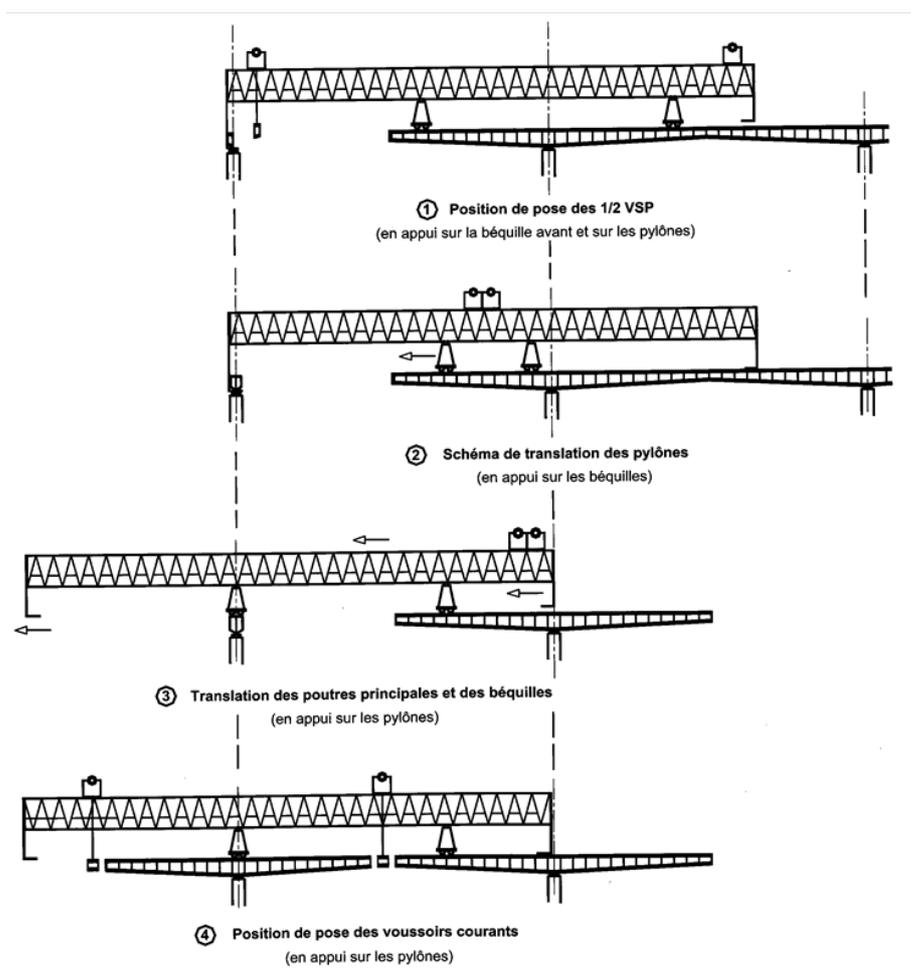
Principe de pose de voussoirs par poutre de lancement
